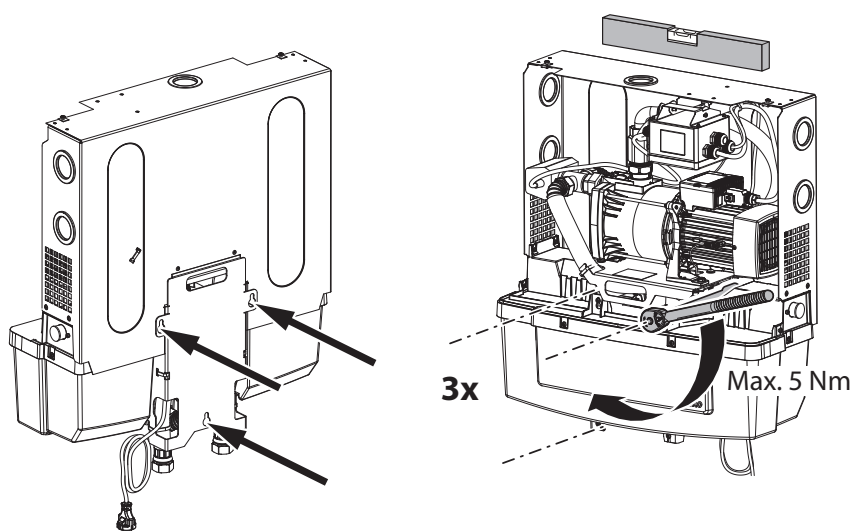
Points d'élingage pour la suspension au mur et serrage des vis
